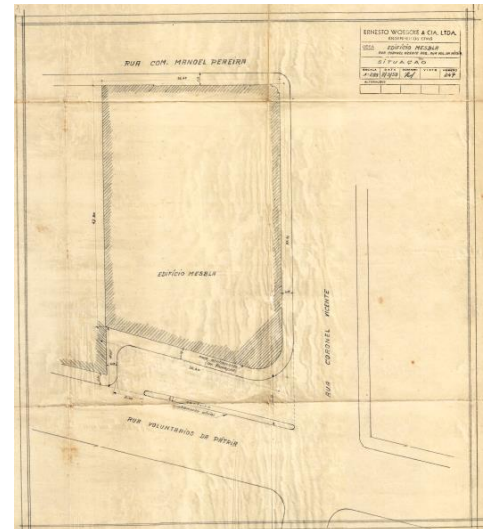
Planta original de implantação do edifício Magazine Mesbla (1944).
